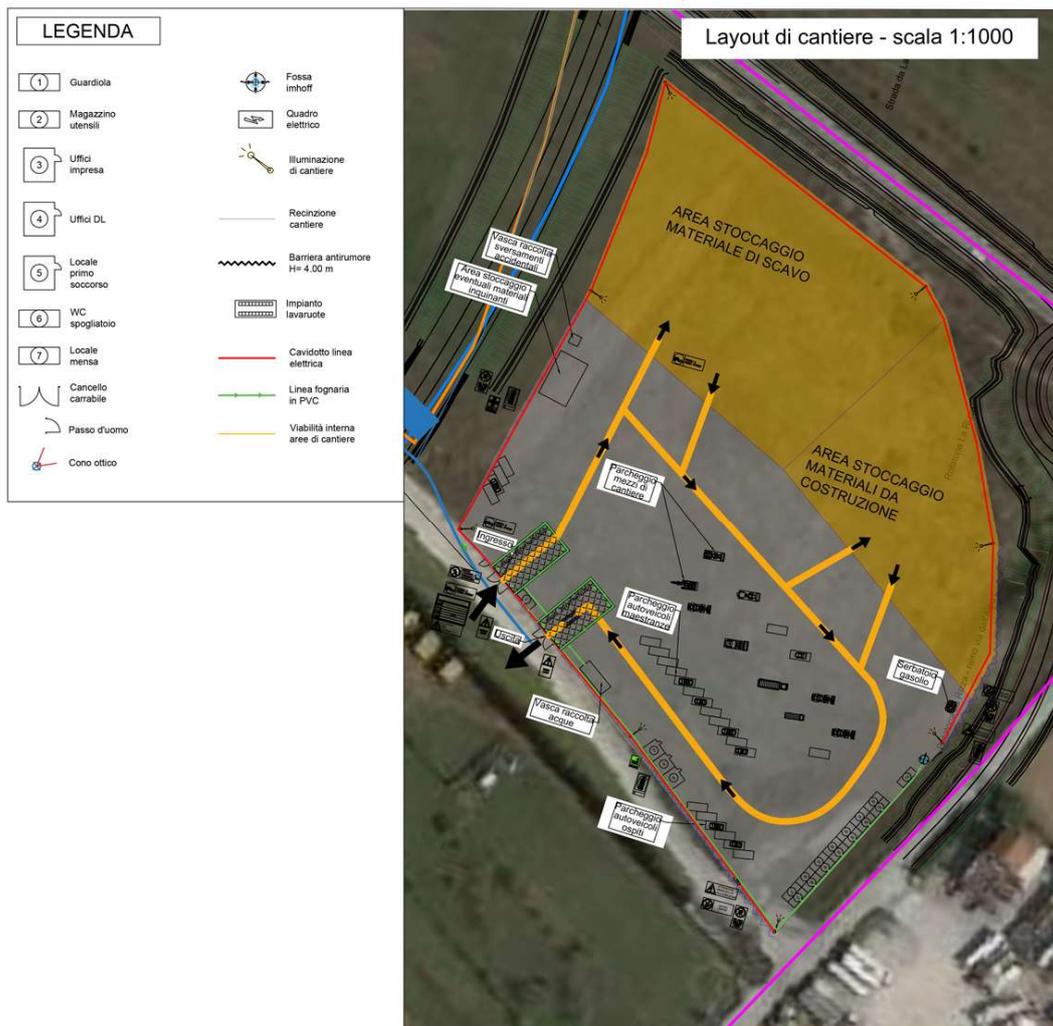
Stralcio planimetrico CB cantiere Base – AS1 Area di stoccaggio1
